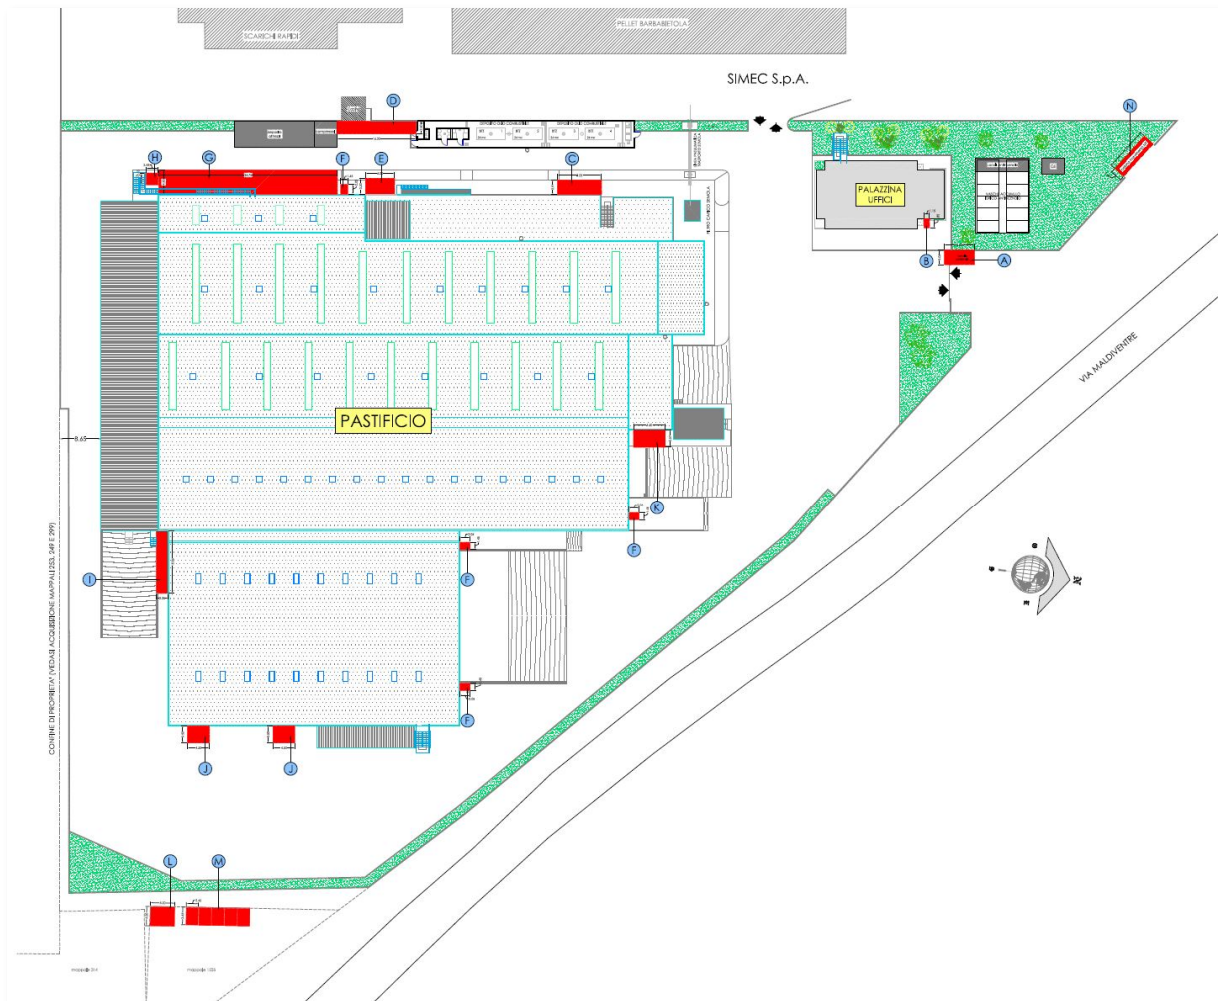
Stralcio Tav.02.1 - Planivolumetrico Stato di Progetto "Autorizzato"
